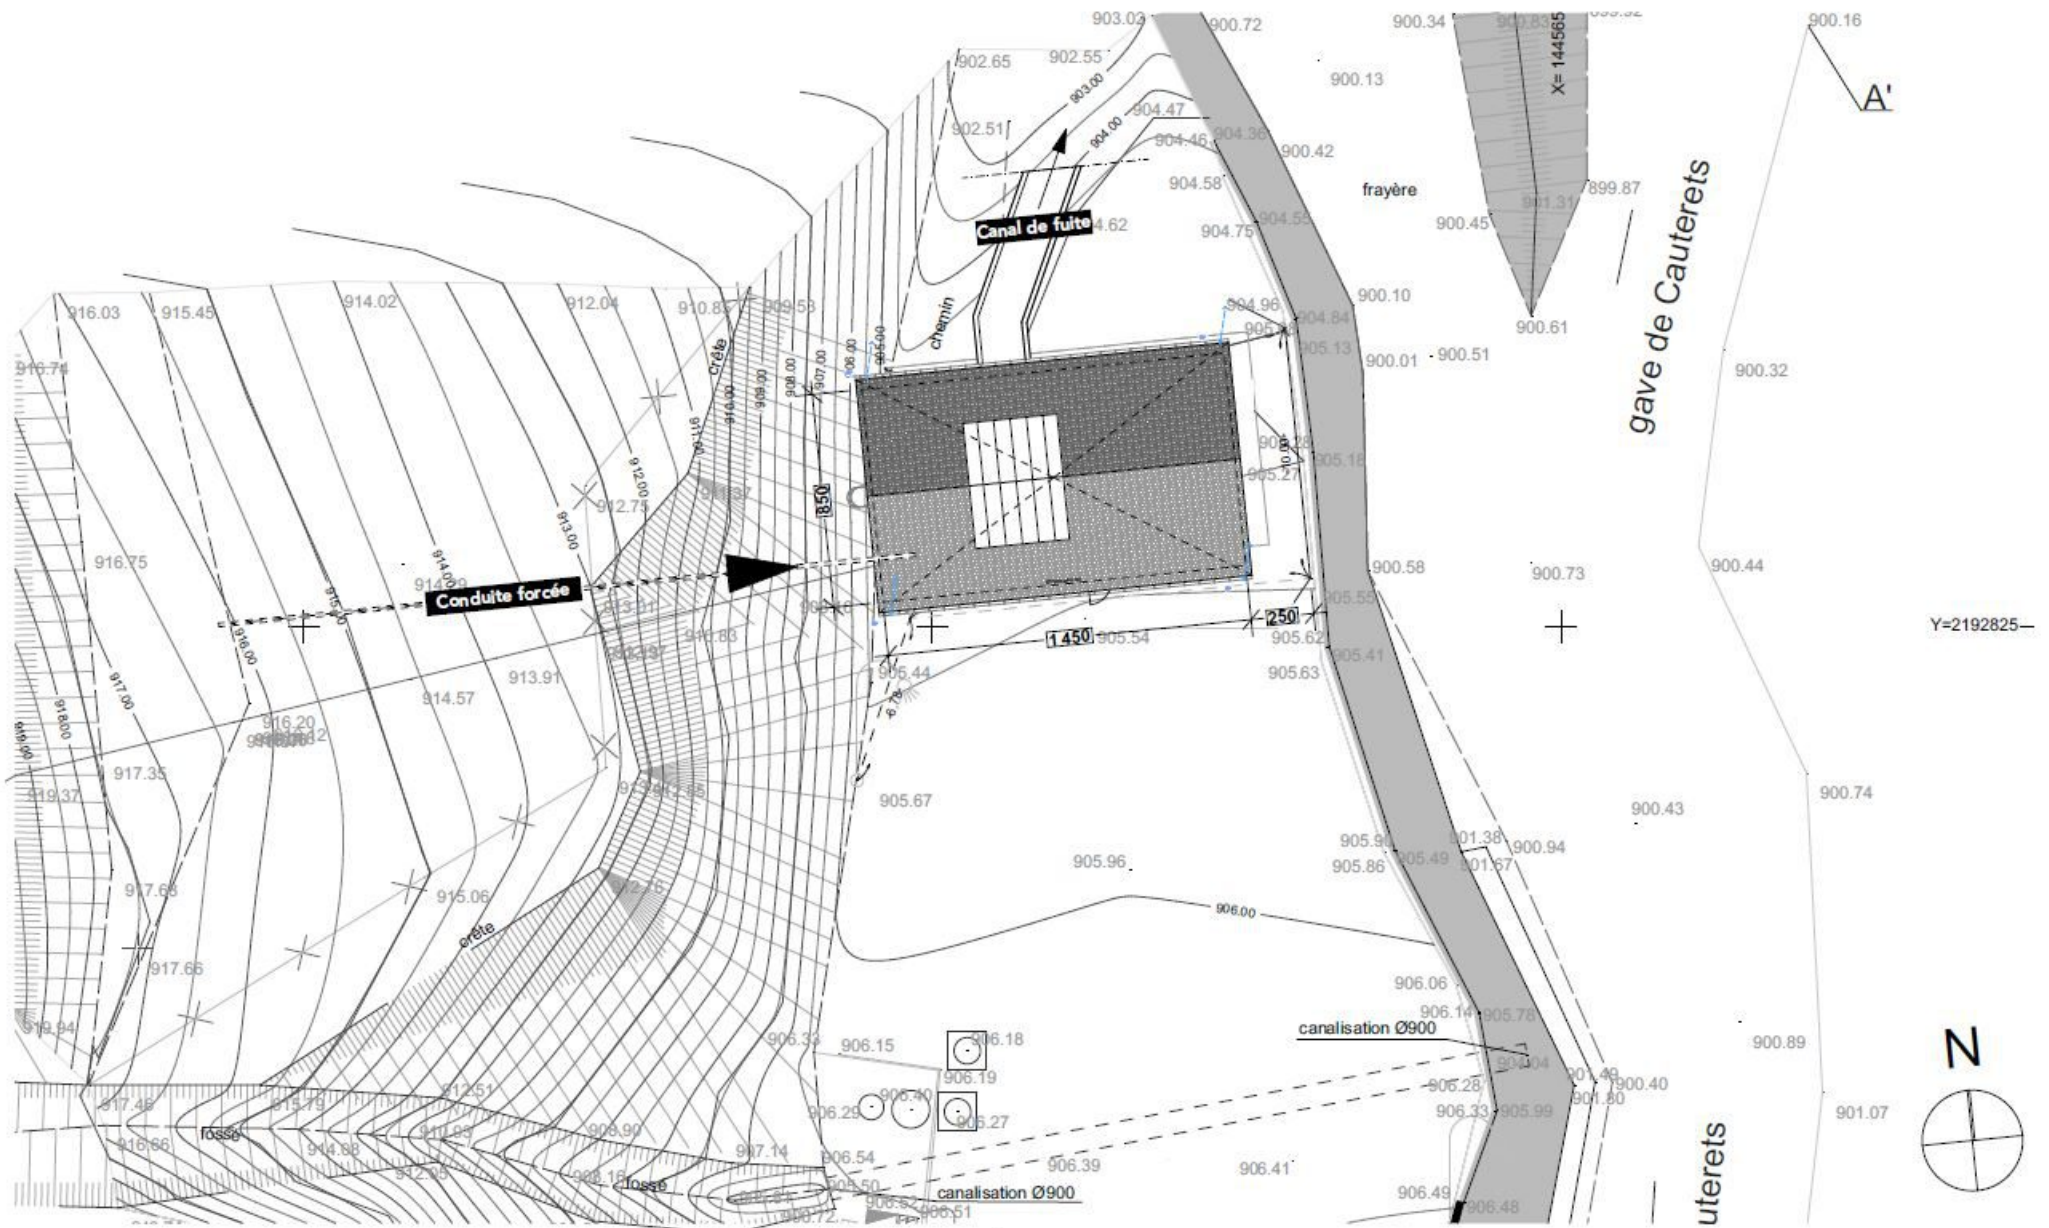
Plan de masse Bâtiment centrale (source : PYREN et BB Architectes Associés)
